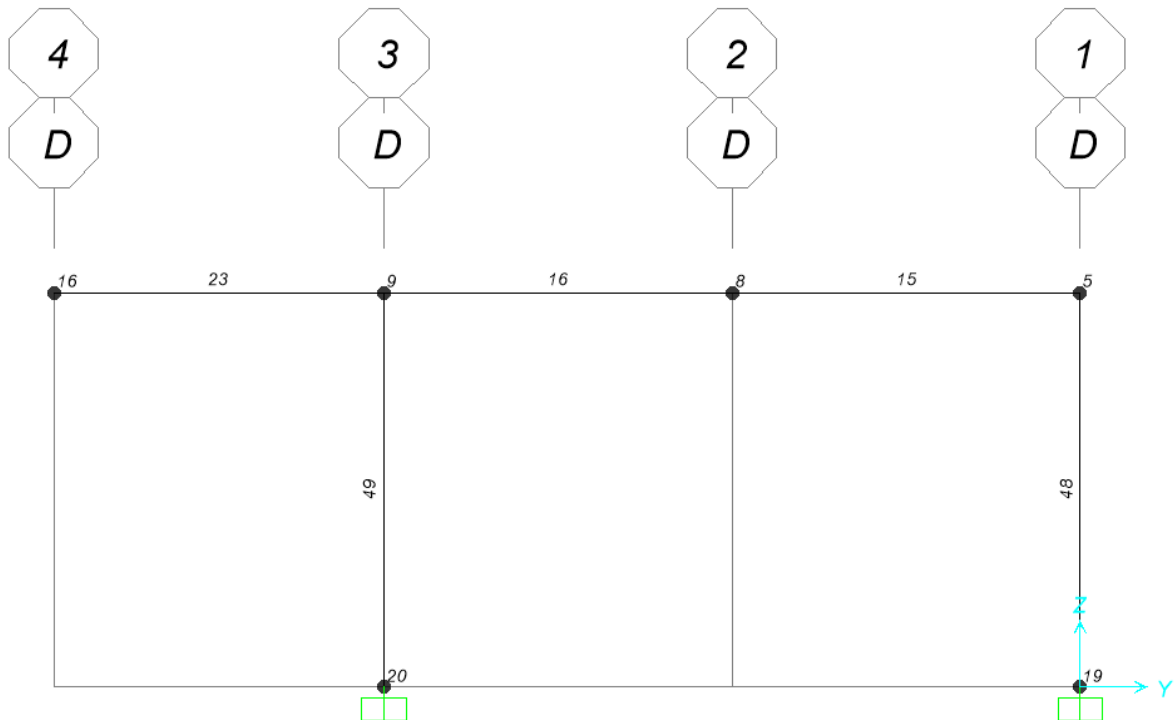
Vista in sezione modello struttura in elevazione –Filo D - numerazione elementi frame e joint
